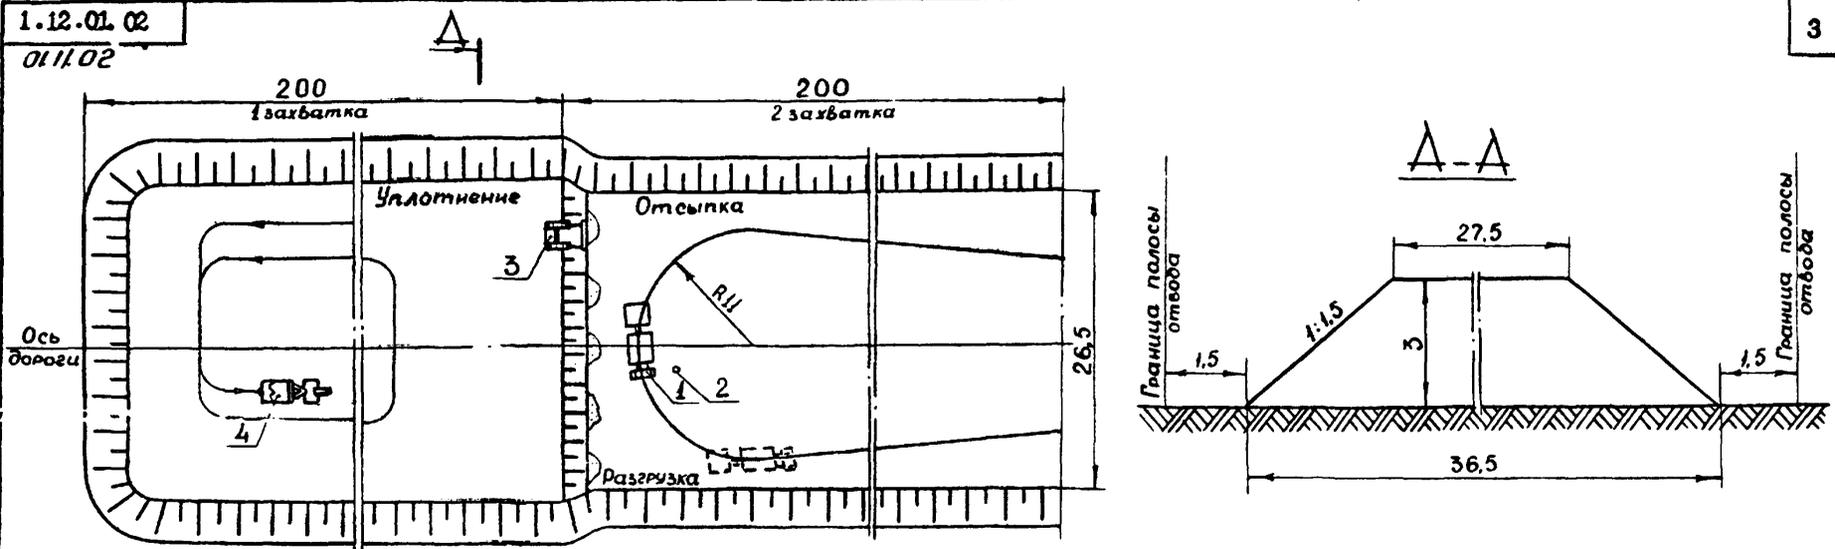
Схема отсыпки грунта при возведении насыпи дорожного полотна
